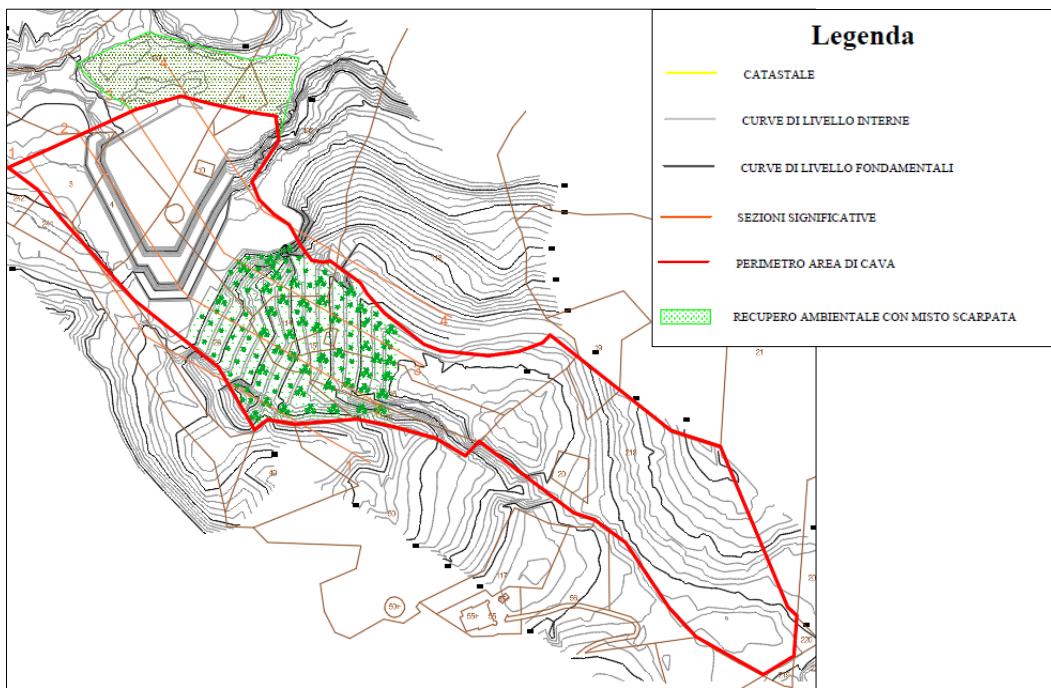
PLANIMETRIA 2° STADIO DI COLTIVAZIONE
